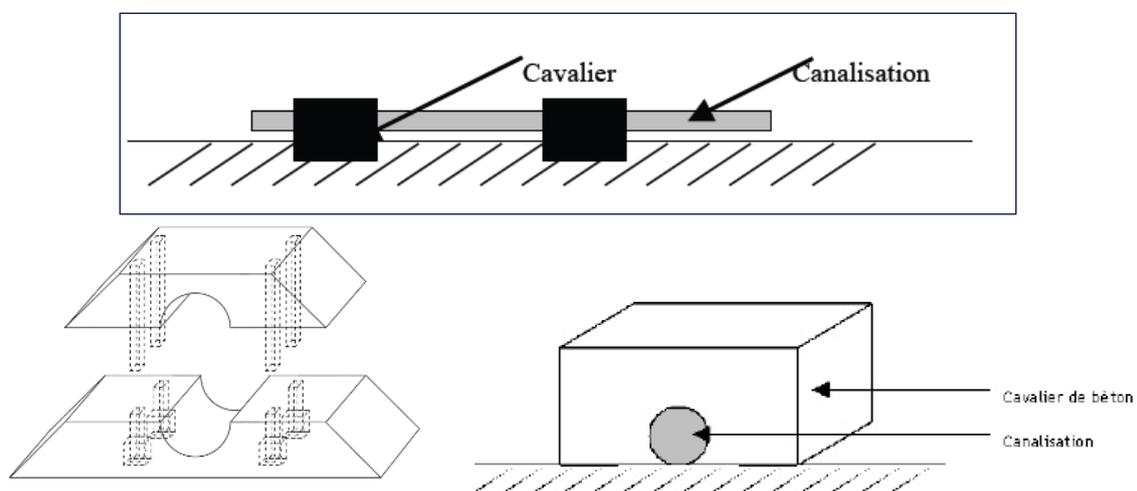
Représentation schématique d'une conduite lestée avec des cavaliers béton
